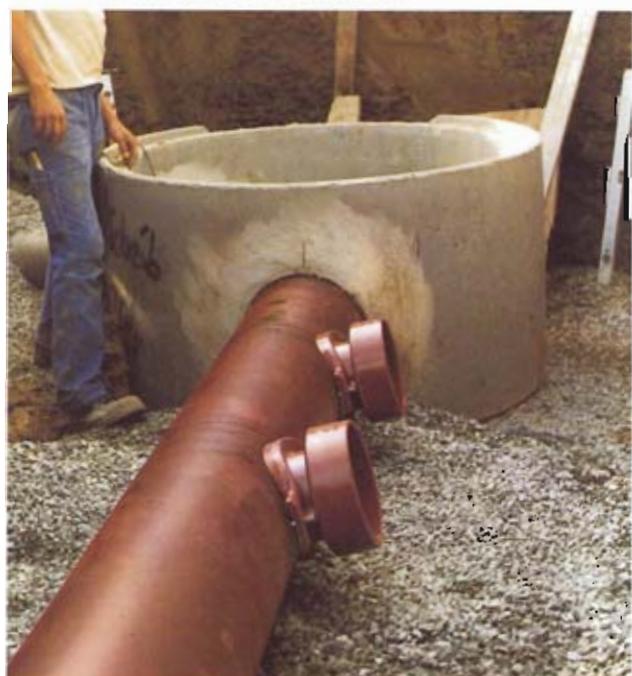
Fertigteilschacht mit TYTON-Schachtanschlußstück
